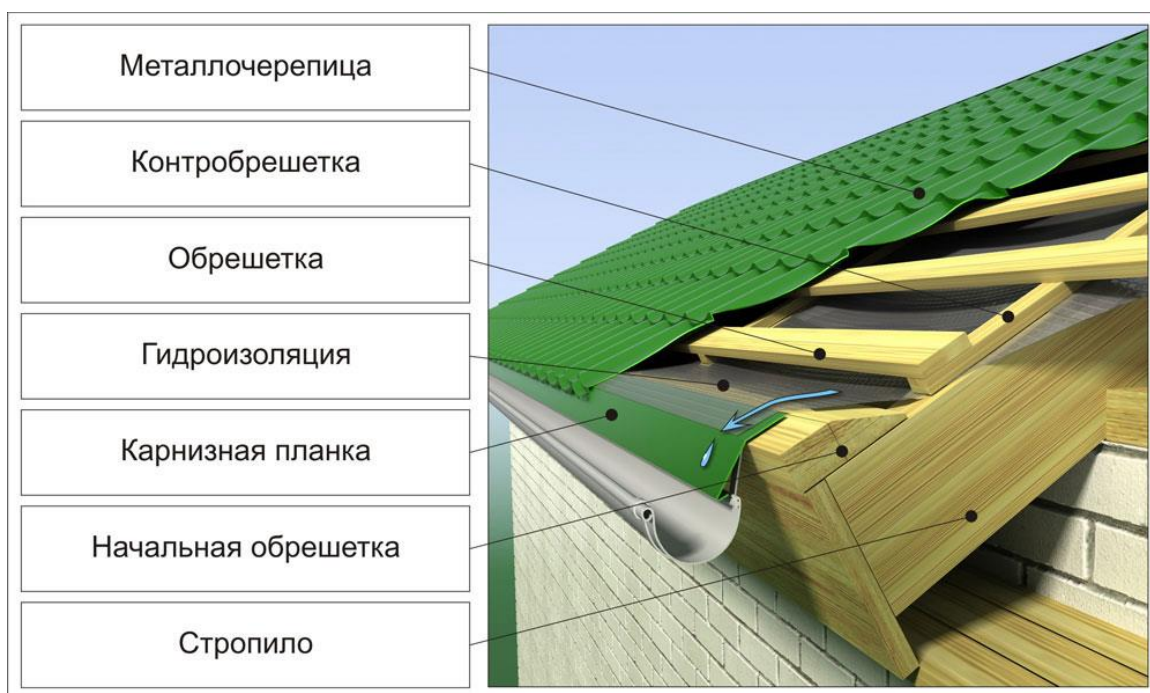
Устройство свеса и подвесных желобов для кровли из профнастила (металлочерепицы) с организованным стоком воды
